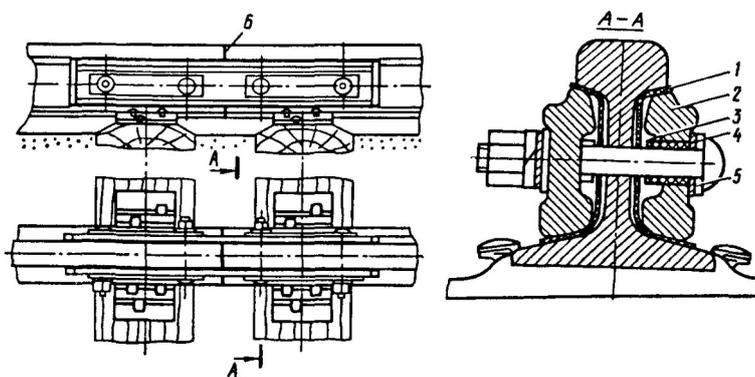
Изолирующий стык с двухголовыми металлическими накладками для пути с деревянными шпалами: 1– боковая прокладка, 2 – накладка, 3 – втулка, 4 – изолирующая планка, 5 – стопорная планка, 6 – торцовая прокладка.
